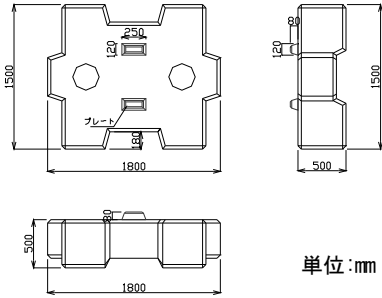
環境活性コンクリートプレートを設置した被覆ブロック詳細図
